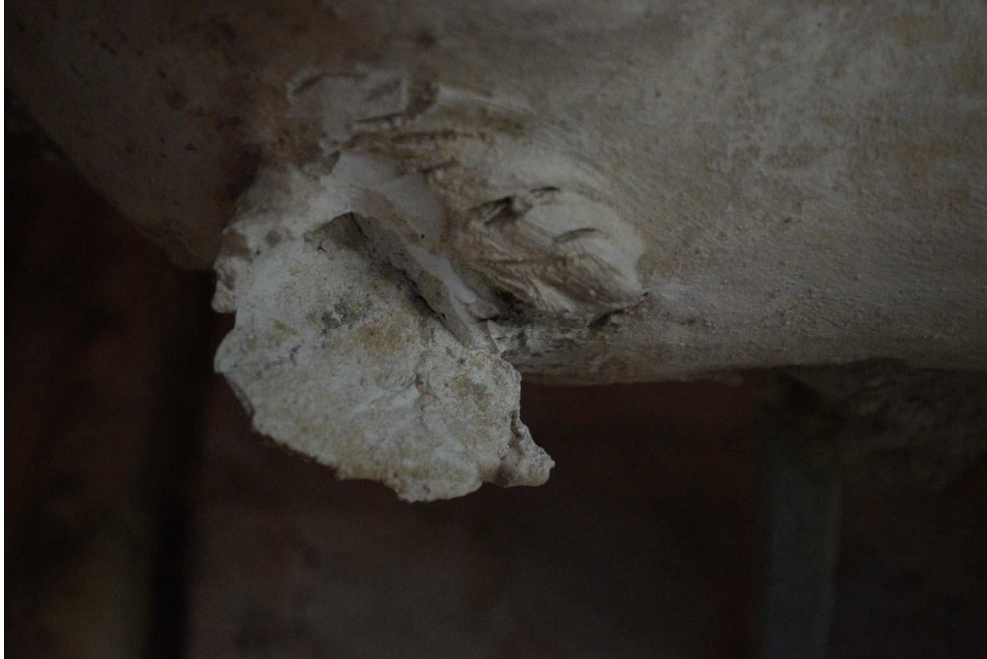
Stav před restaurováním, detail poškození, prasklina, solné výkvěty
